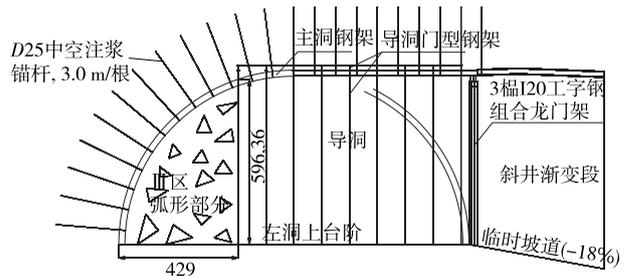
导洞范围内正洞上台阶施工示意图(单位:cm)
